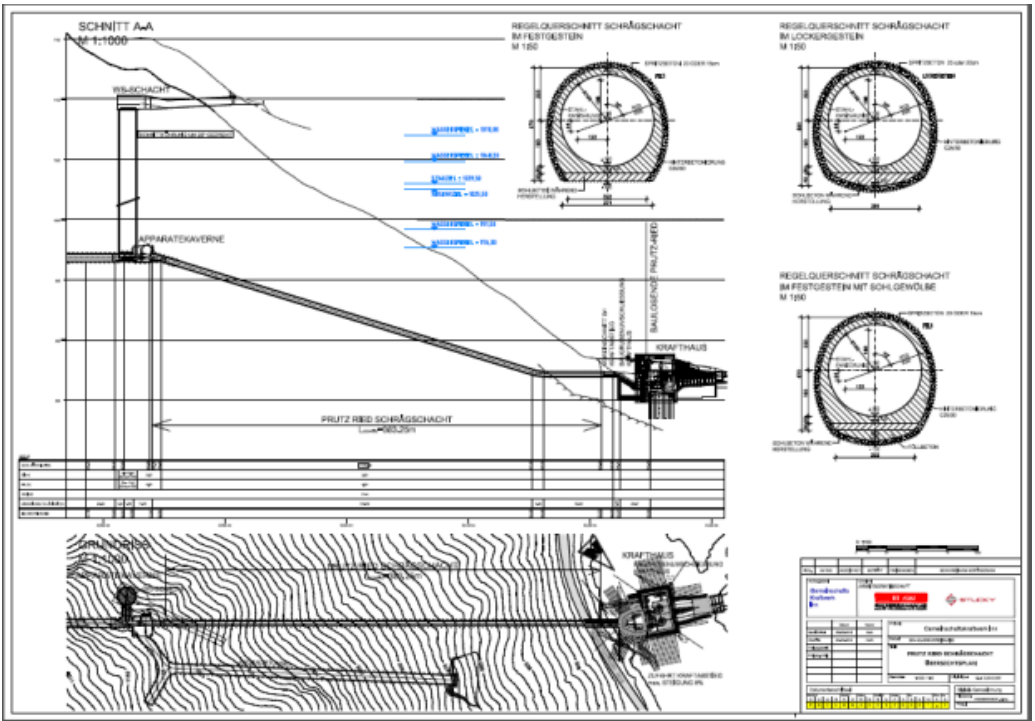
Perfil geotécnico (GKI, 2014)
